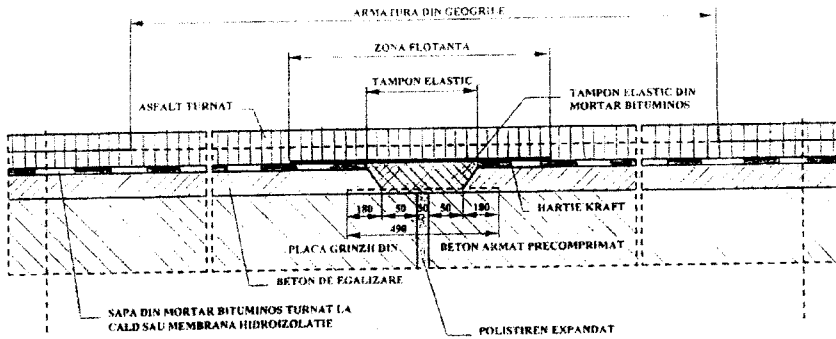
Secțiune longitudinală prin rost din asfalt turnat armat cu plasă de sârmă
